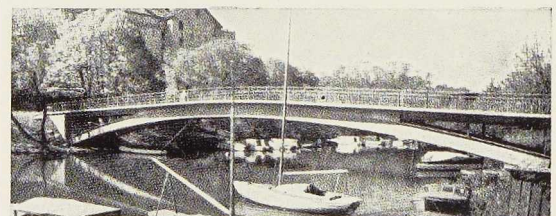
Pont du chantier naval de Mälaren, construit en 1947, dont l'arc d'une portée de 52^m50 comporte un surbaissement de 1 : 14,8.
